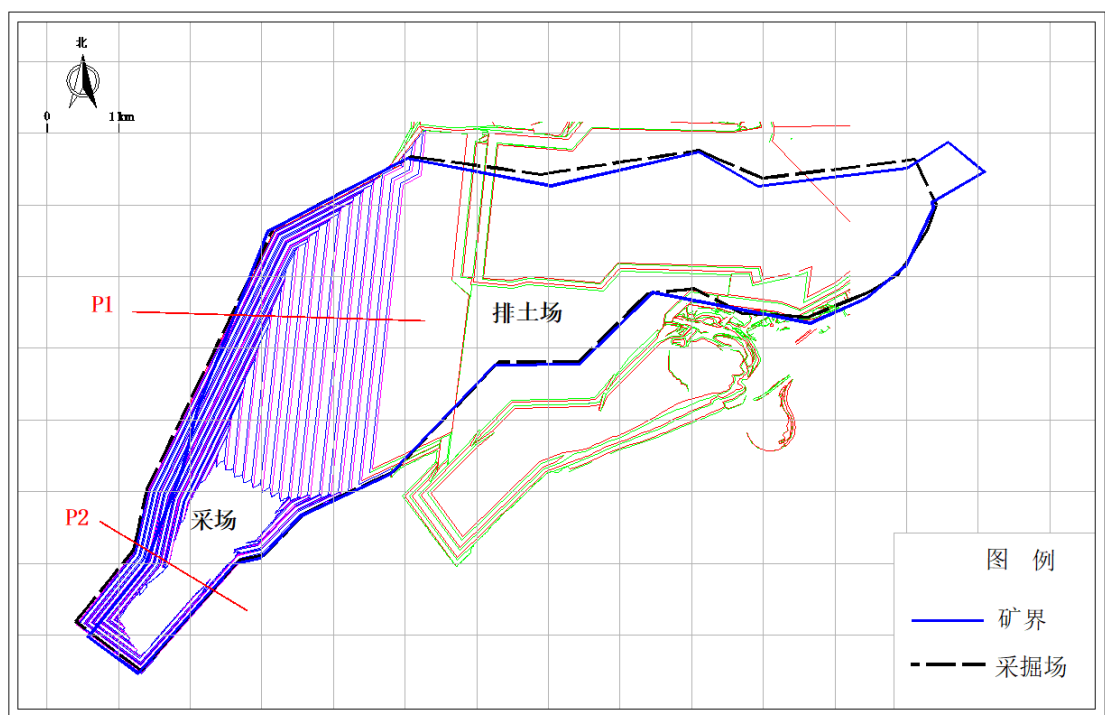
扎哈淖尔露天煤矿采掘场最终平面图
